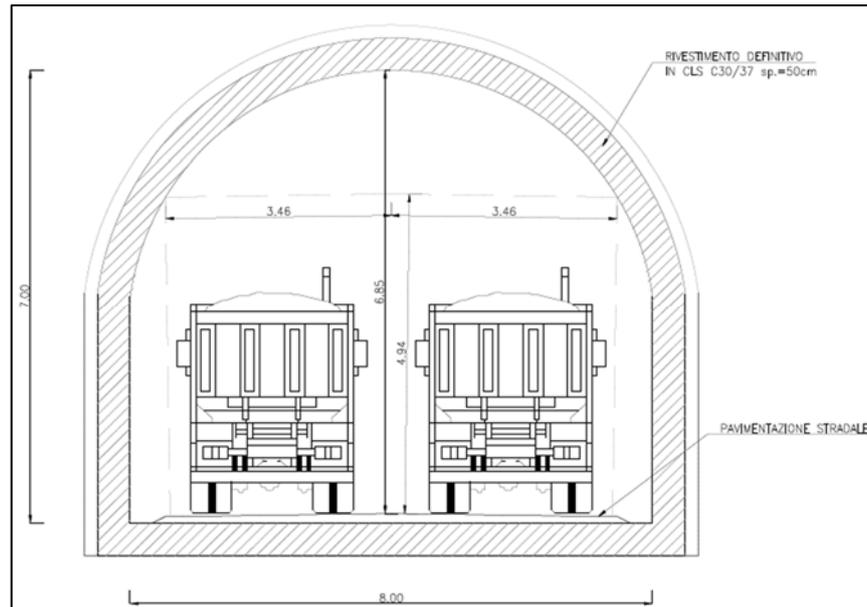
Sezione tipo della galleria d'accesso alla camera alla base del pozzo piezometrico
